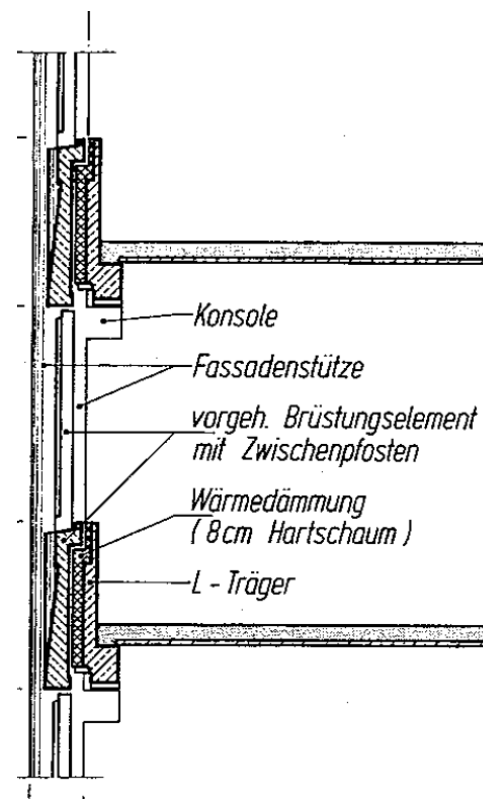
Fassadenschnitt<sup>1</sup>
